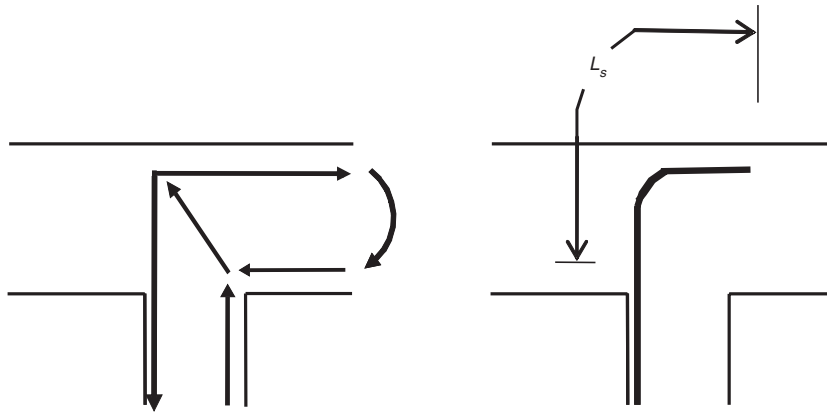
Detalle de anclaje de la armadura de la pila hacia el interior de la misma
